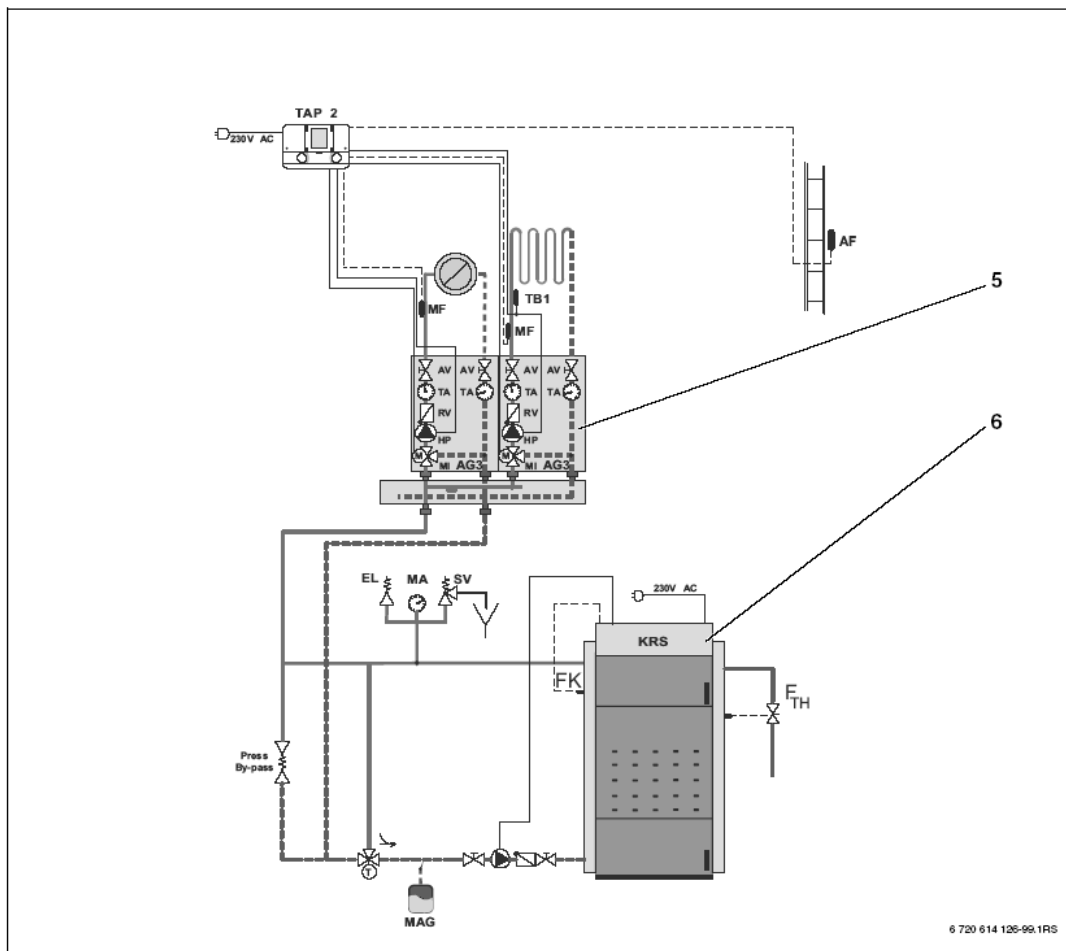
Schemă de montaj partea hidraulică P01 cu un singur cazan de încălzire
